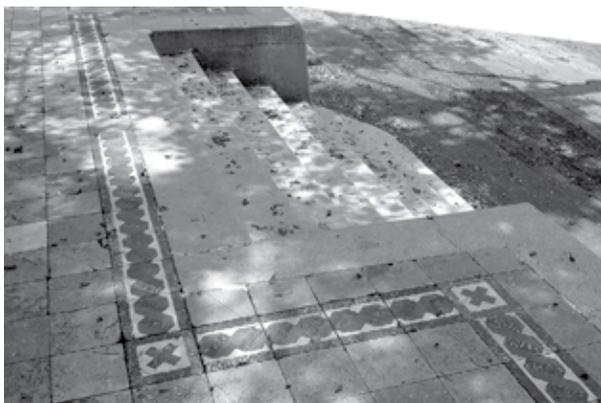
Detalle de pavimentos de pasta en plataforma de desplante y el perímetro de terrazo, 2014. Archivo Alejandro Leal.
